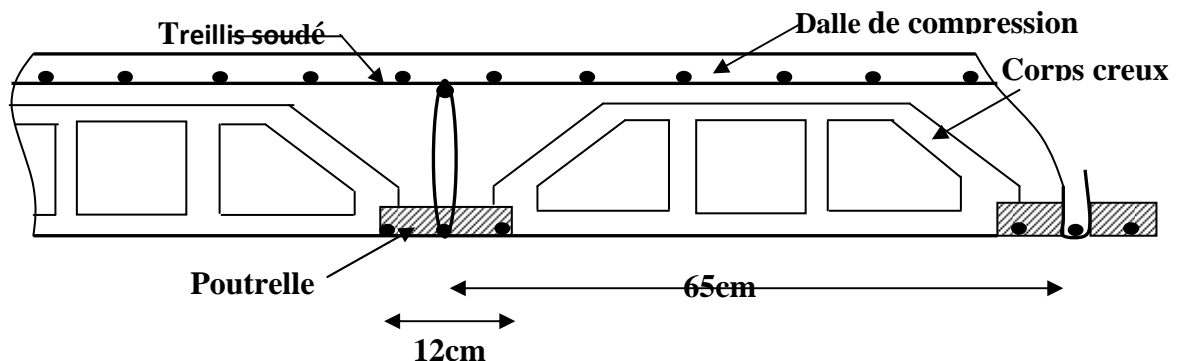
Coupe transversale sur un plancher à corps creux.
